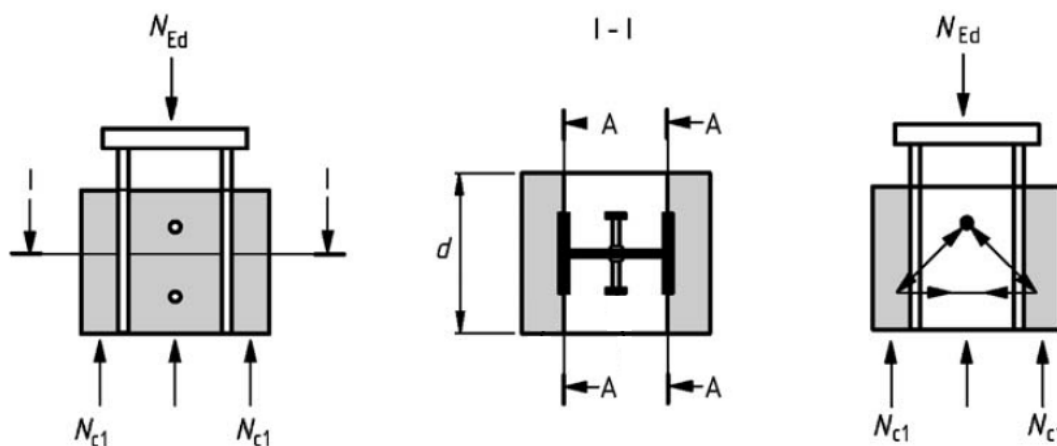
Непосредственно прикрепленные и некрепленные части бетонного сечения при расчете поперечного армирования
